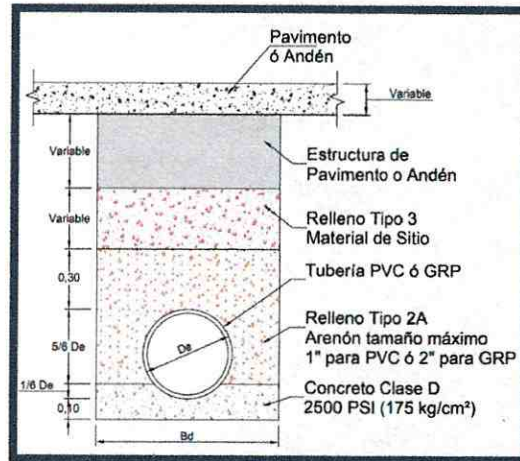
Cimentación típica de tubería para pendientes entre 20% y 33%
